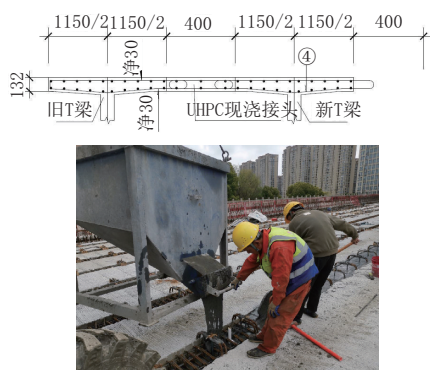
T 梁 UHPC 湿接缝构造和现场施工照片(单位:mm)
